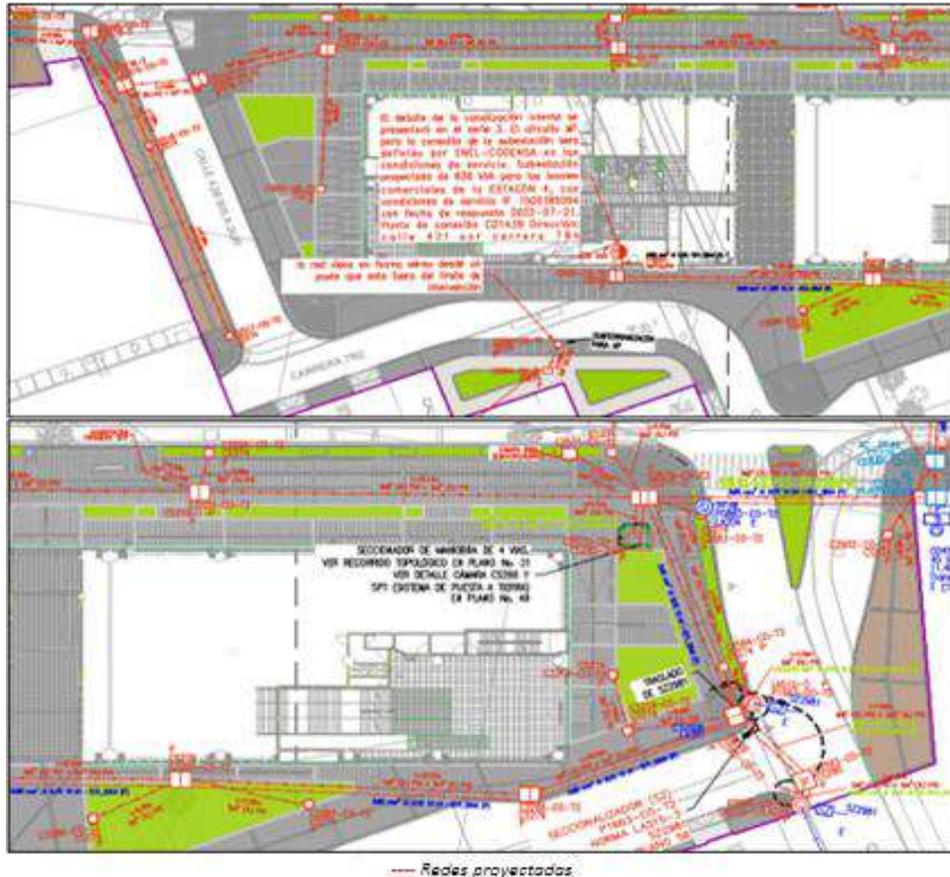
Plano de localización general de la red ENE2-STA4 entre Pilas E4-1 a E4-7
